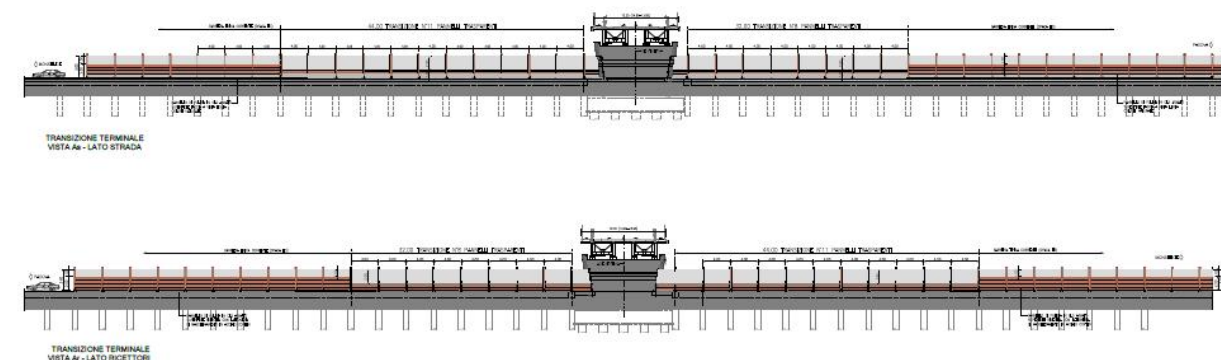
Schema di chiusura delle barriere acustiche h 3 m sulla spalla dei cavalcavia a tre luci
